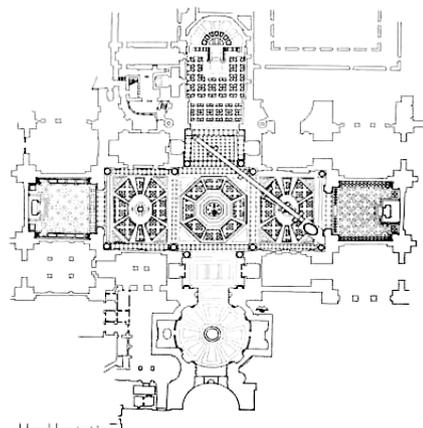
Planta baixa Igreja de Santa Maria degli Angeli
